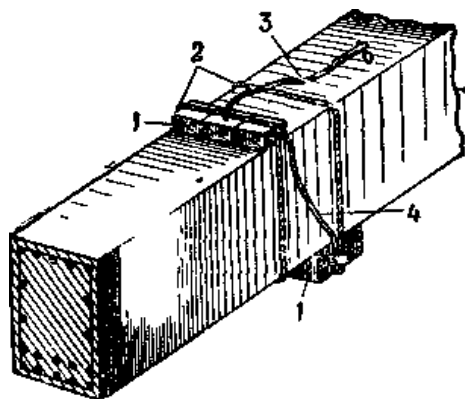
Расчлененное расположение заряда на взрываемой железобетонной балке:
